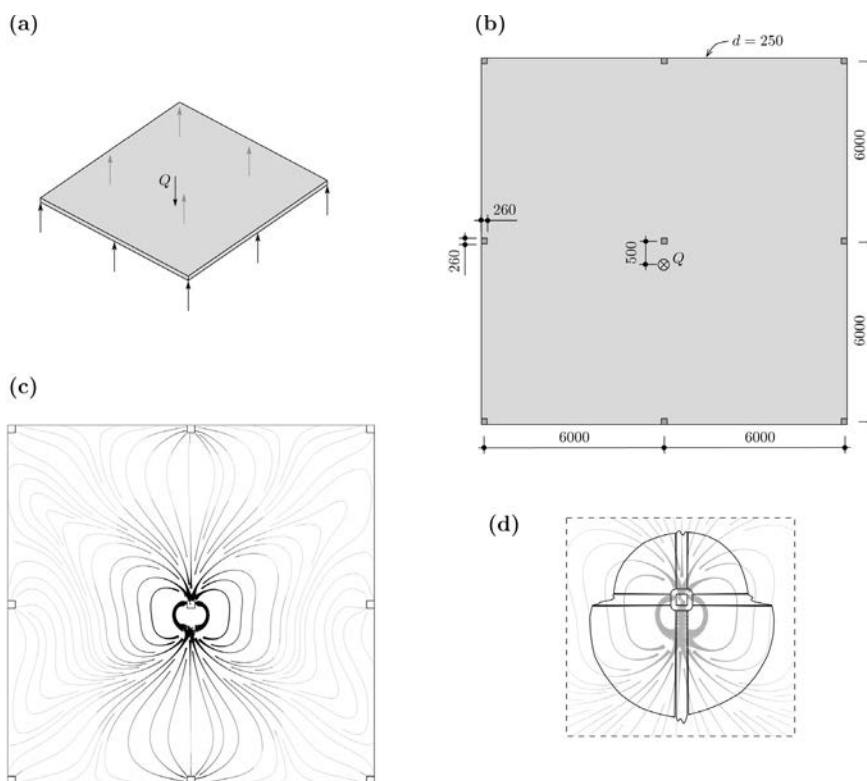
Losa apoyada sobre nueve columnas simplemente apoyadas y sometida a una carga puntual: (a) esquema de la losa y cargas; (b) dimensiones (cotas en [mm]); (c) campo de esfuerzos cortantes; y (d) reparto de los esfuerzos cortantes alrededor de la columna central.
